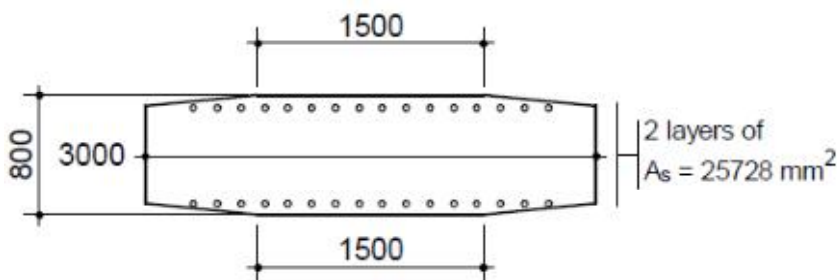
Esquematisação da armadura dos pilares para as forças longitudinais
